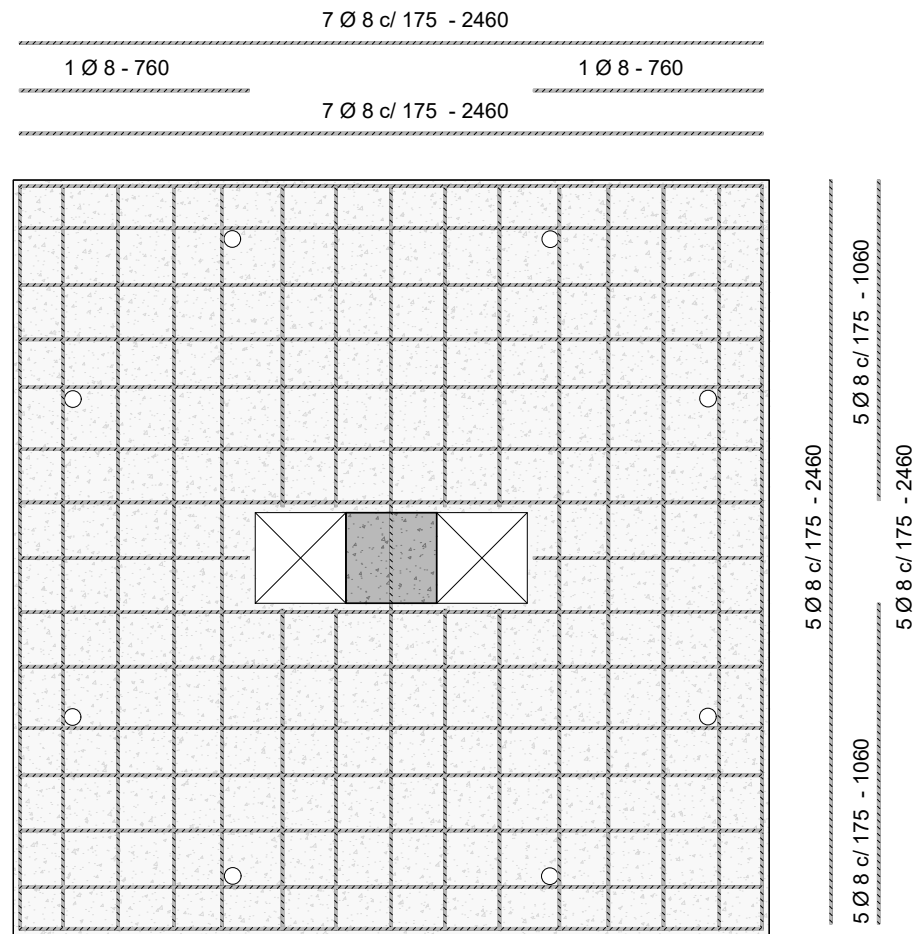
Armaduras de flexão positiva das lajes com aberturas
